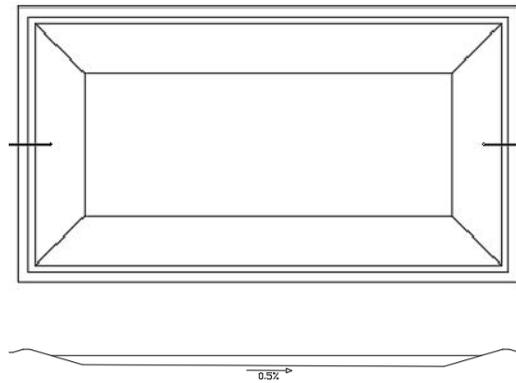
Detalle planta y alzado de lagunas anaerobias. Fuente: edición propia
